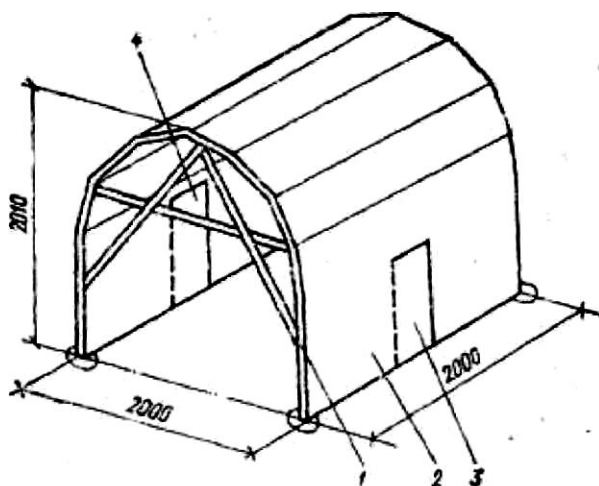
Будка для укрытия места сварки: 1 – каркас; 2 – брезент; 3 и 4 – окна для вентиляции
